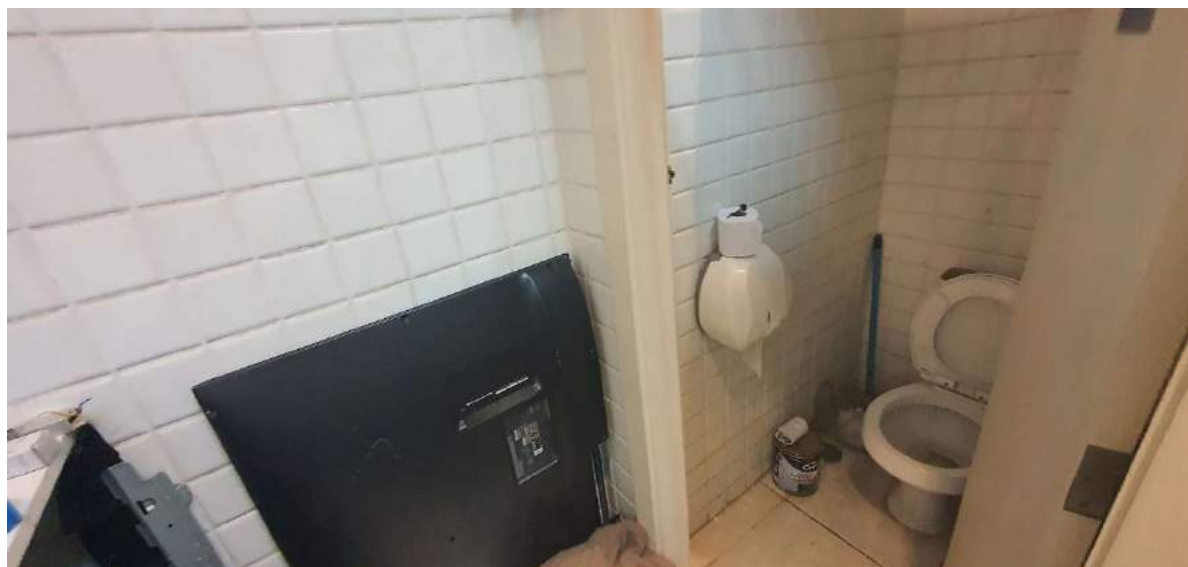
BANHEIRO DIREITO, CONTINUAÇÃO 2.
